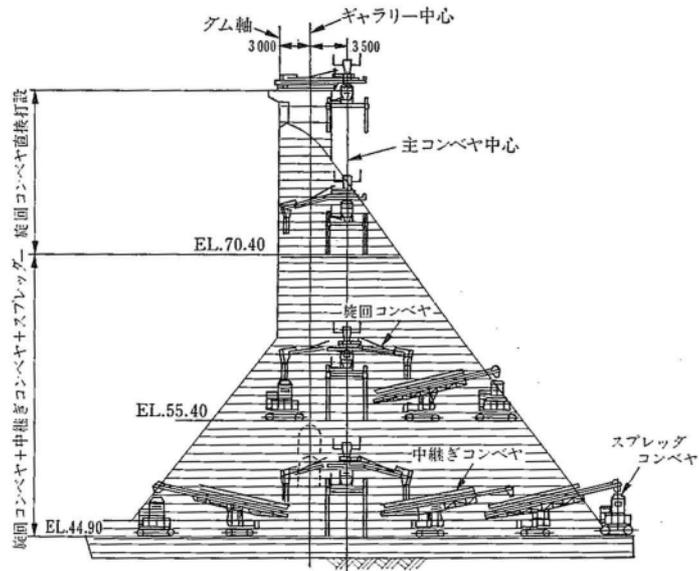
3 - 12 BCP 工法におけるコンベヤ配置図 (小平ダム)
